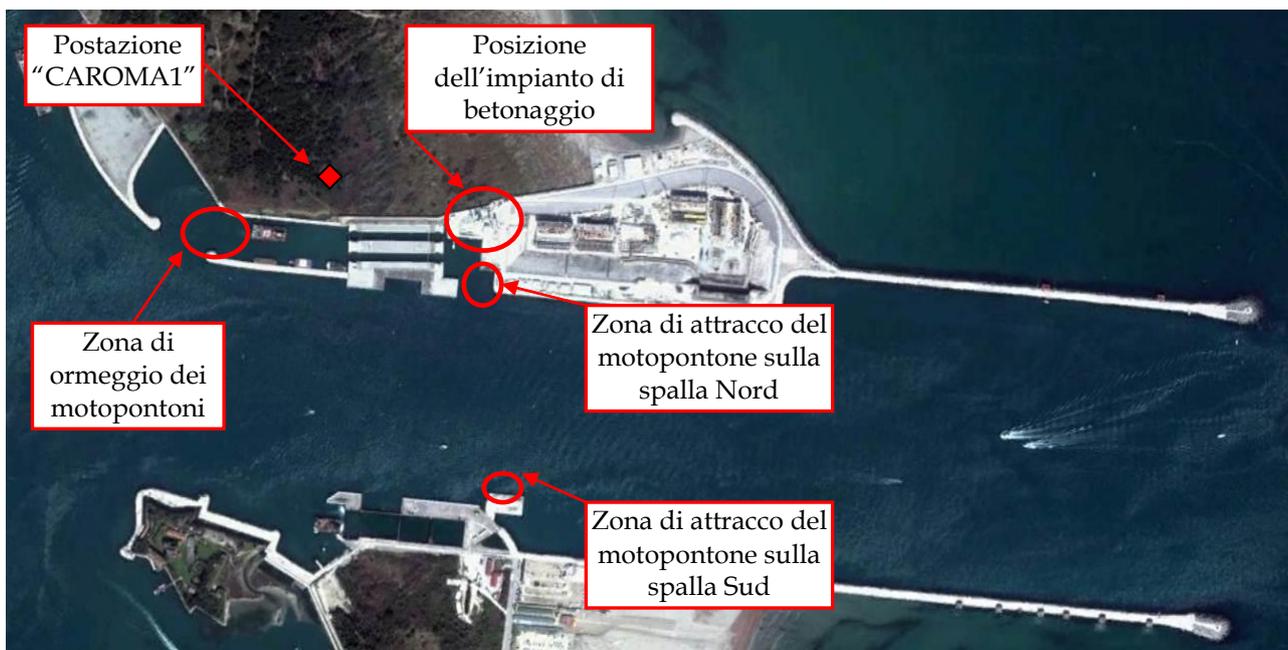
Individuazione della postazione di misura CAROMA1, della posizione dell'impianto di betonaggio, della zona di ormeggio dei motopontoni nel porto rifugio e della zona di attracco del motopontone impiegato per il trasporto dei mezzi di cantiere sulla spalla Nord.
